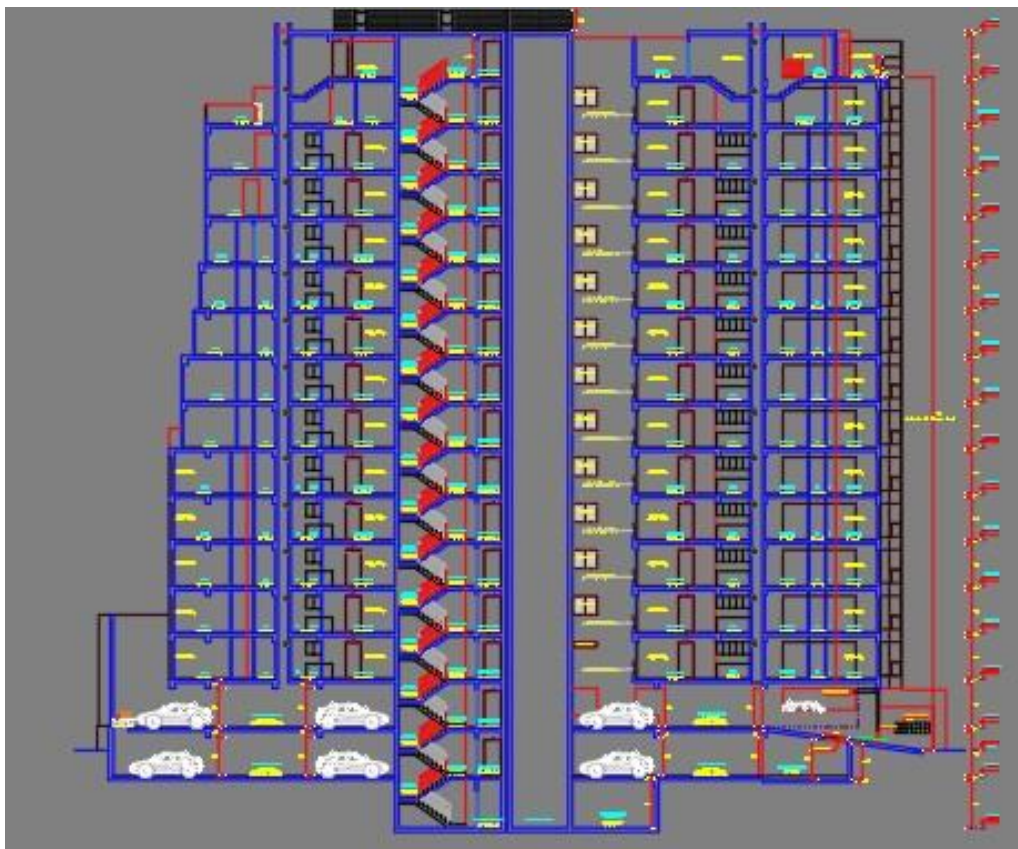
Corte de la edificación, 14 pisos + 1 sótano.
